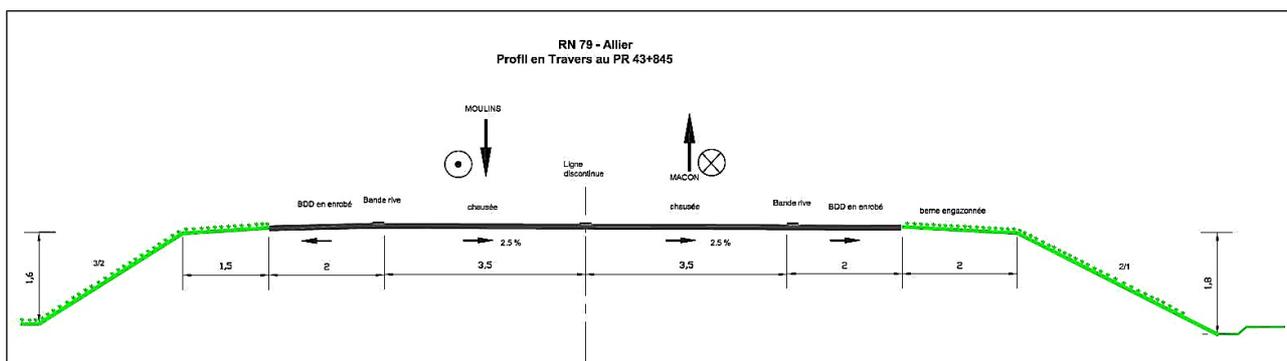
Profil en travers de la chaussée au niveau de la zone de l'accident
